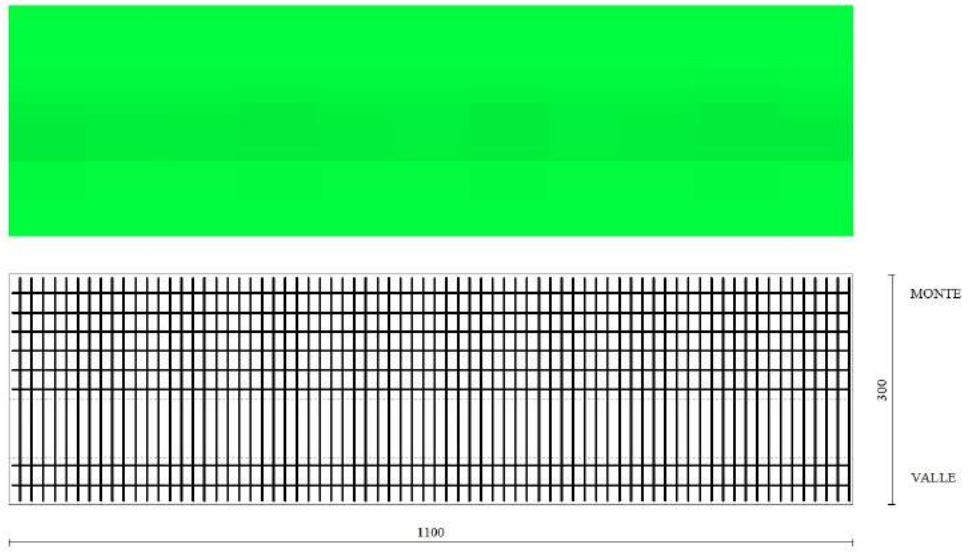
Piastra fondazione dir. Y (Inviluppo)
